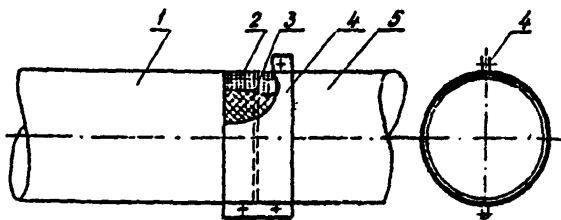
Бандажное соединение воздухопроводов: 1,5 - стыкуемые воздухопроводы; 2 - липкая лента; 3 - тканевая прокладка; 4 - стальной бандаж
